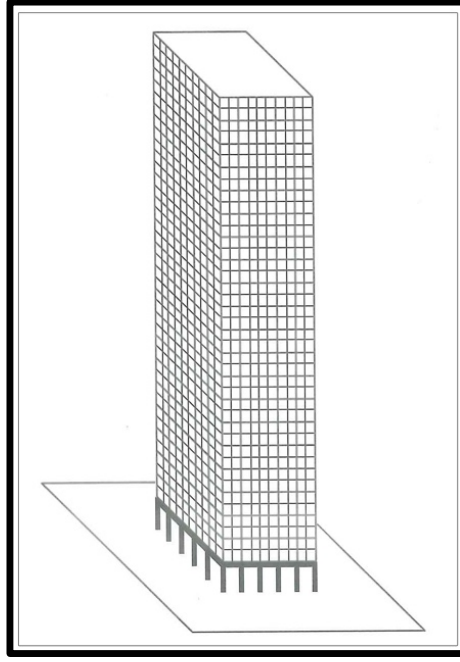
World Trade Center Twin Towers, New York, ABD, 1972
